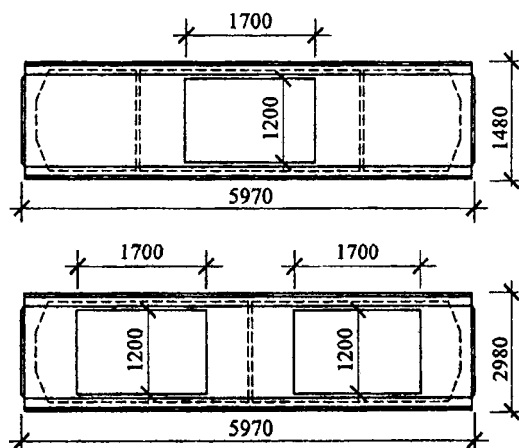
Железобетонные ребристые плиты покрытий пролетом 6 м
